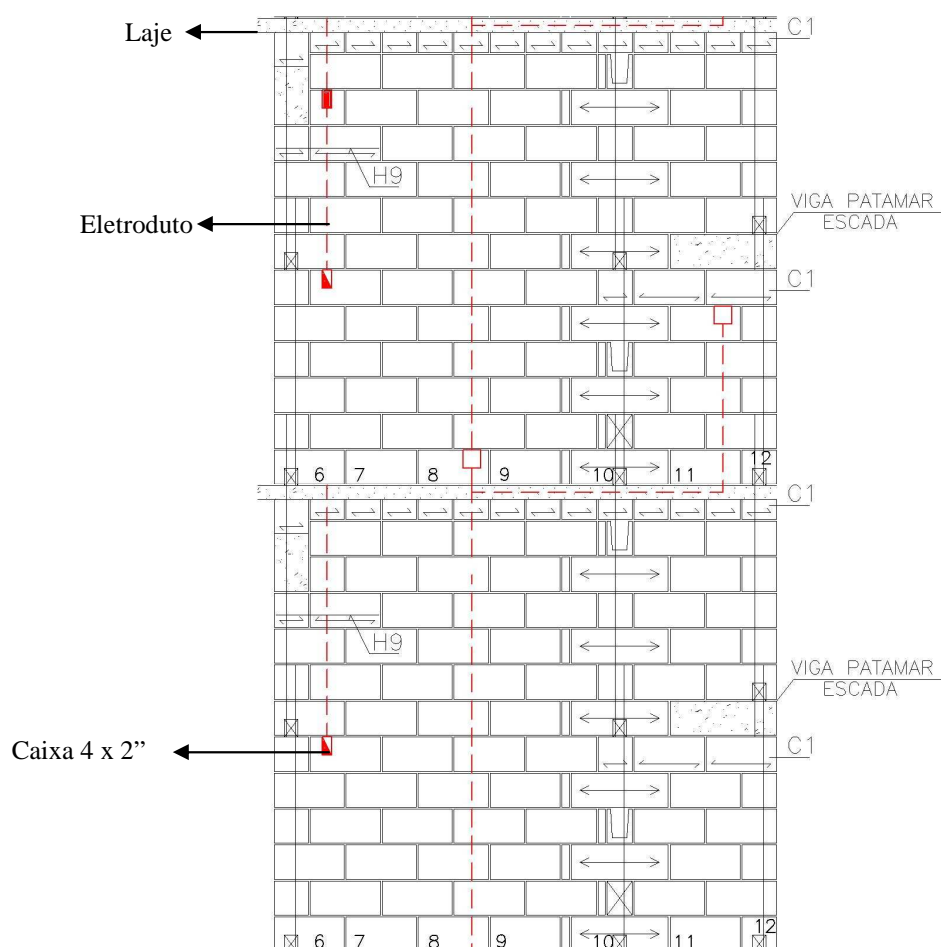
Infraestrutura das instalações presente no desenho das elevações da alvenaria.
